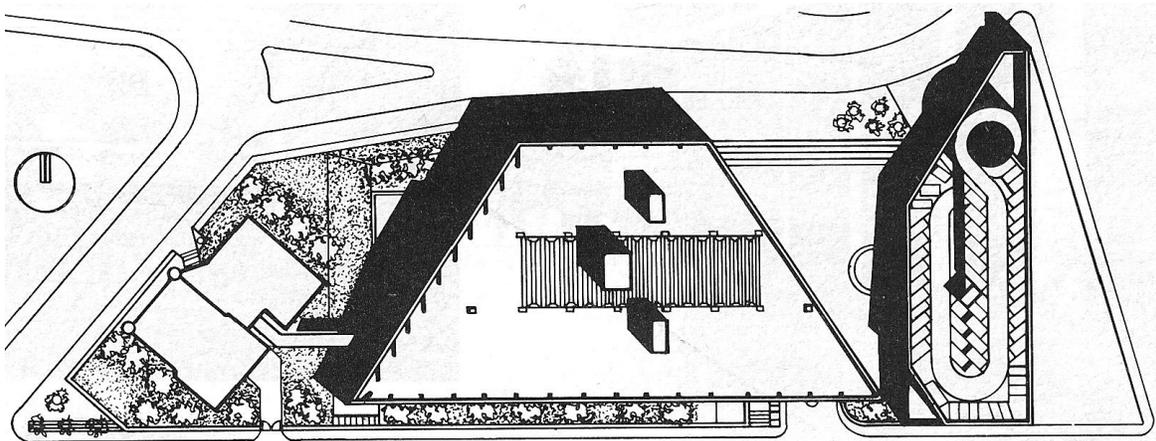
Planta de Conjunto de las oficinas generales del Infonavit. Fuente: FRMH.
